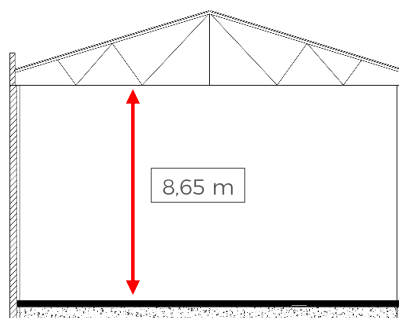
Sección Nave de Prensas - Plaza de la Taronja 1 y 3, Picanya.
